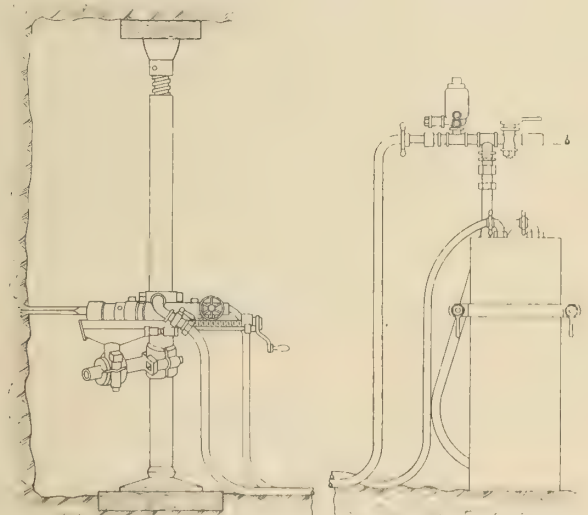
Preßluftbohrmaschine mit Spülwassereinführung. Leyner Engineering Works, Denver, Colorado.
